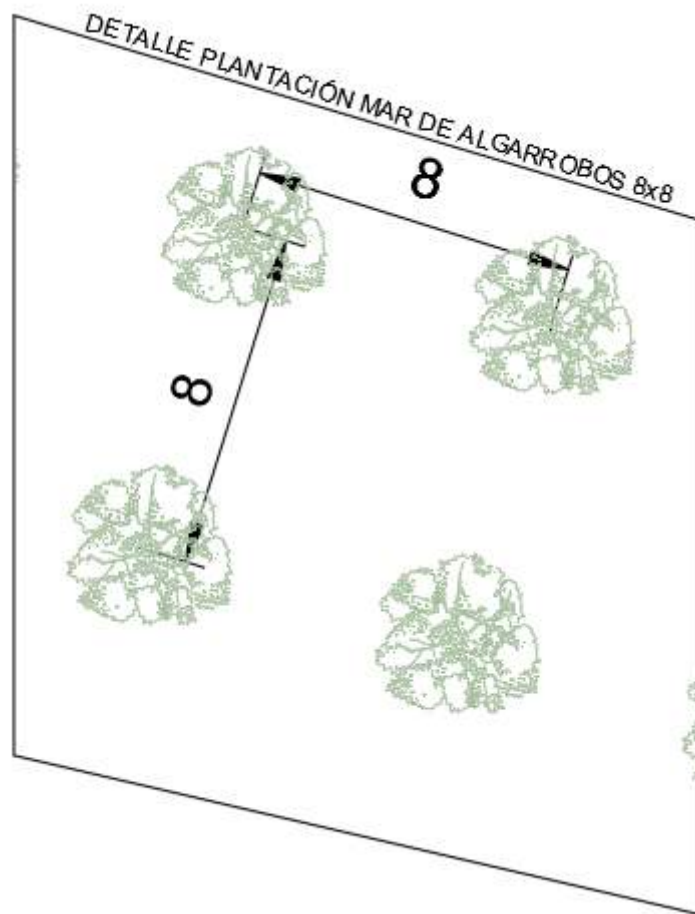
Detalle mar de plantación de algarrobos cada 8 metros
